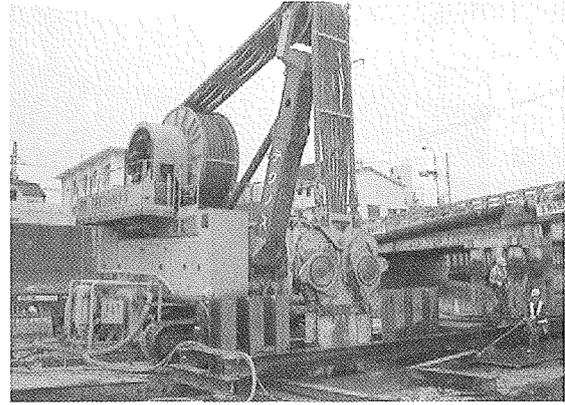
正蓮寺東工区開削トンネル工事の施工状況
